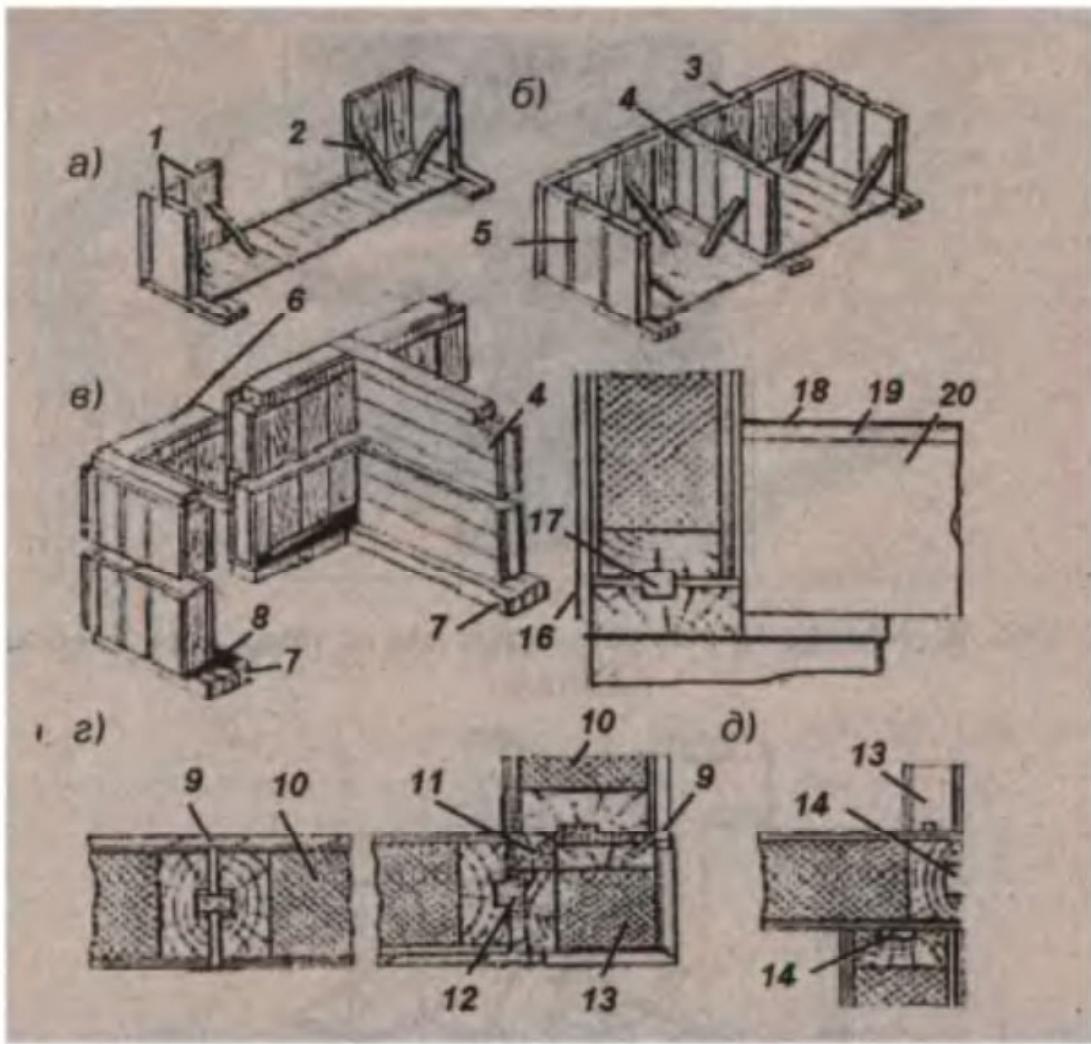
Монтаж панельных домов: а, б - установка панелей в углах и их временное крепление; в - укладка обвязки; г, д - схемы соединения панелей; 1 - панели наружных стен; 2 - раскос временного крепления; 3 - торцевая стена; 4 - средняя стена; 5 - продольная стена; 6 - верхняя обвязка; 7 - цокольная обвязка; 8 - пакет из гидроизоляции и утеплителя; 9 - нащельник; 10 - наружная стеновая панель; 11 - бруск; 12 - пакля; 13 - вкладыш; 14 - рейка; 15 - перегородка; 16 - цоколь; 17 - рейка; 18 - линолеум; 19 - древесноволокнистая плита; 20 - панель перекрытия
